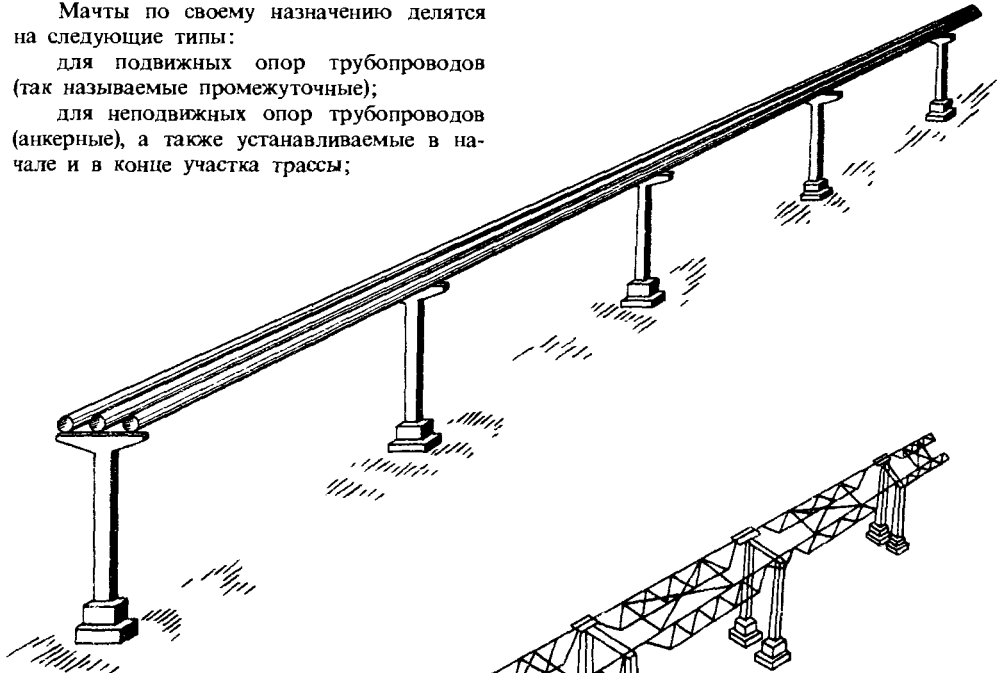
Прокладка трубопроводов на отдельно стоящих мачтах
